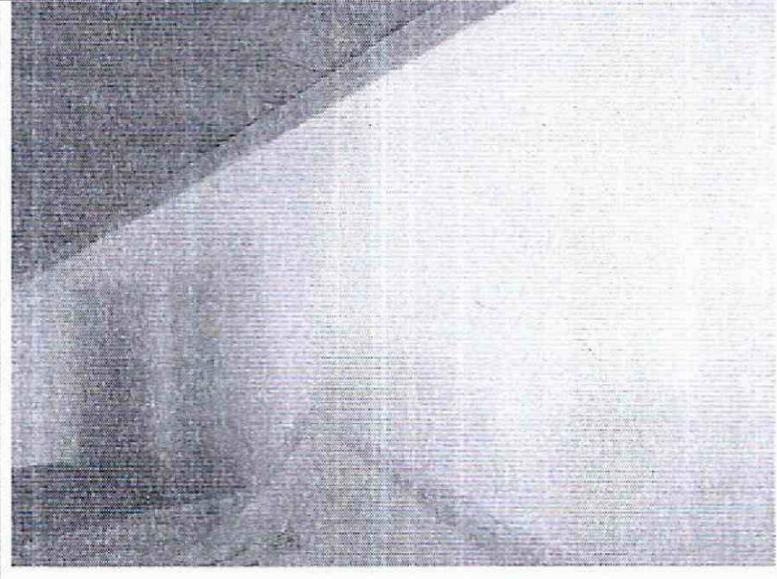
Muros de segundo piso extremo sur con fisuras.
